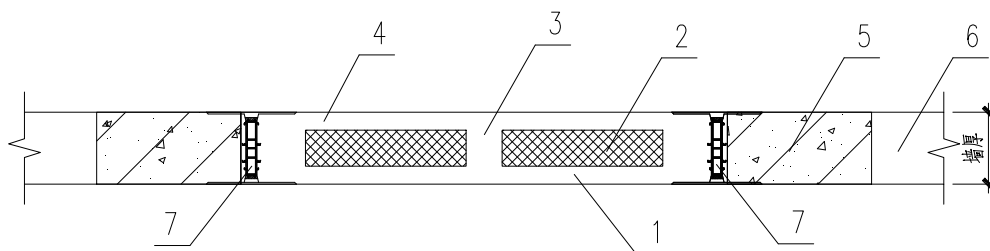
内置保温板现浇混凝土外围护墙墙身构造二
